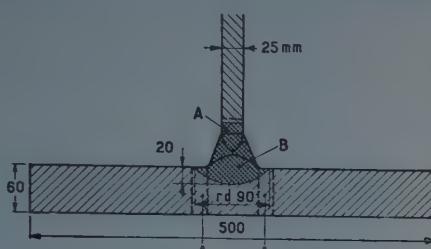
Pont du Zoo à Berlin (coupe sur la fissure).
